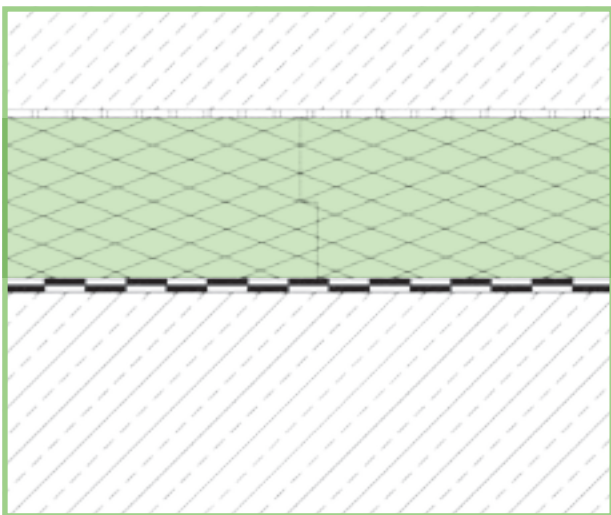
Struttura di un tetto rovescio a terrazza con lastre in calcestruzzo su letto di pietrisco.
